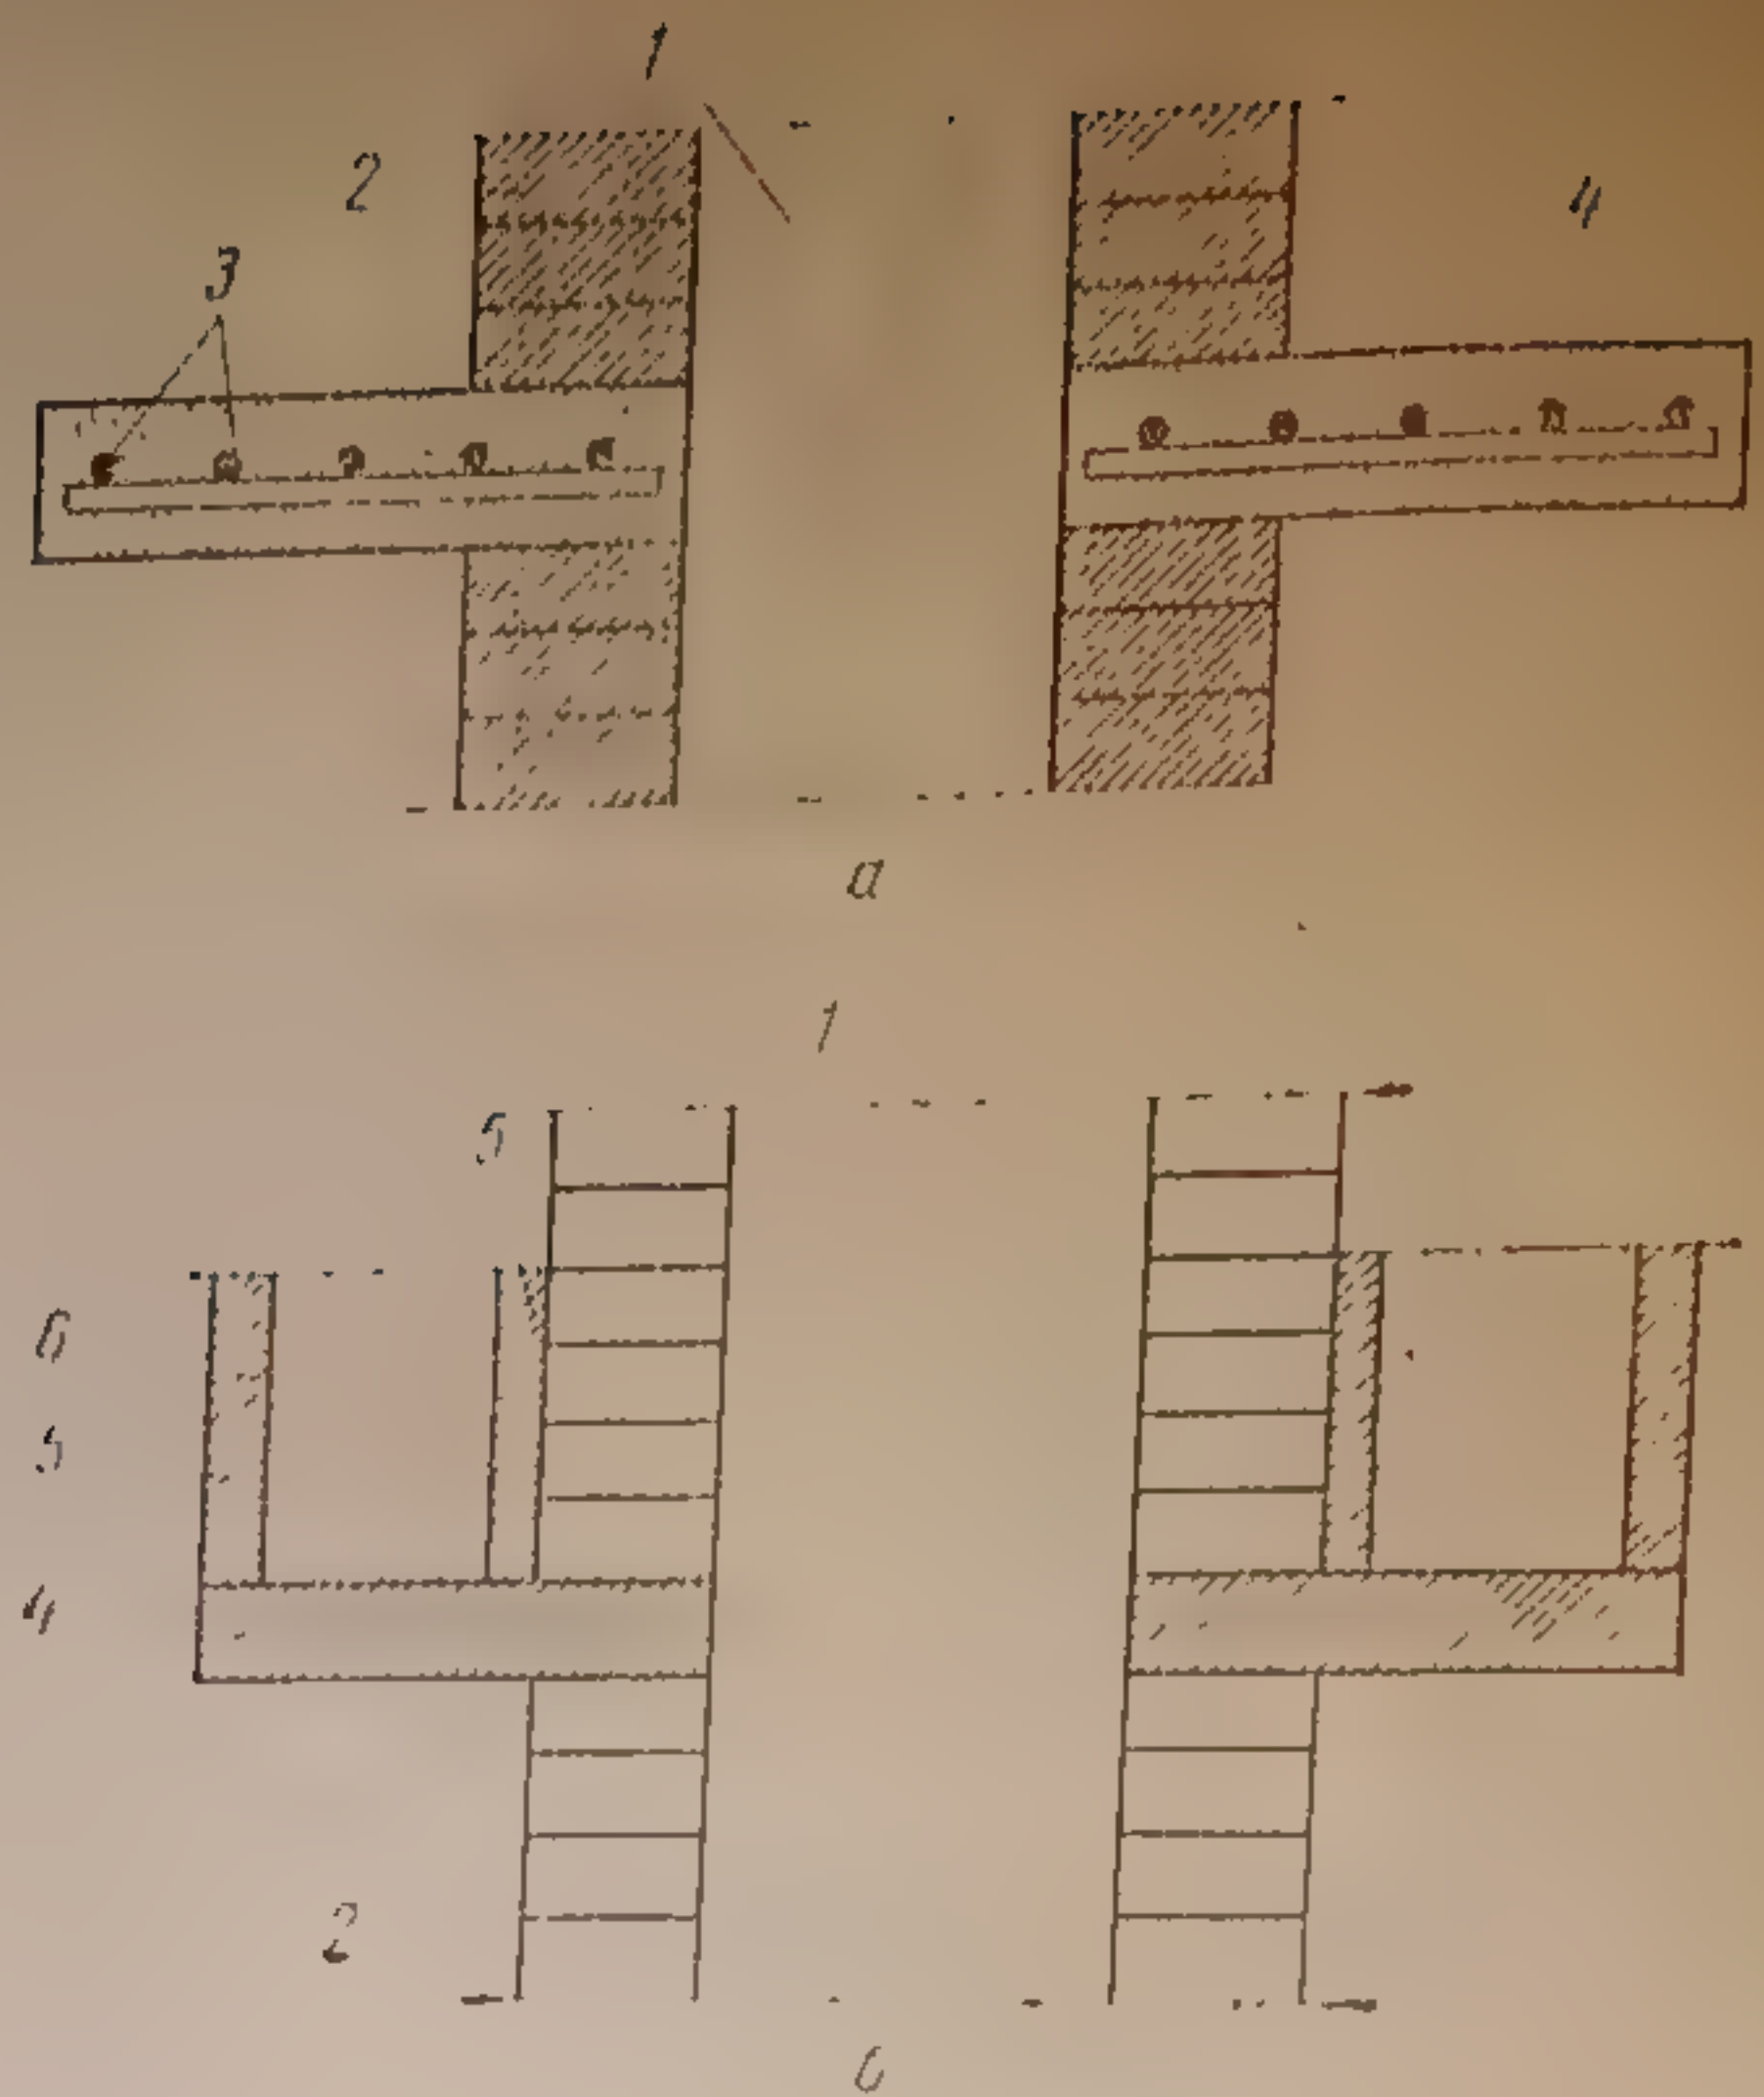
Распушки: а — из железобетона; б — в виде ящика с песком: 1 — дымоход; 2 — кирпич; 3 — арматура; 4 — бетон; 5 — стенки ящика (асбоцемент, бетон); 6 — песок
